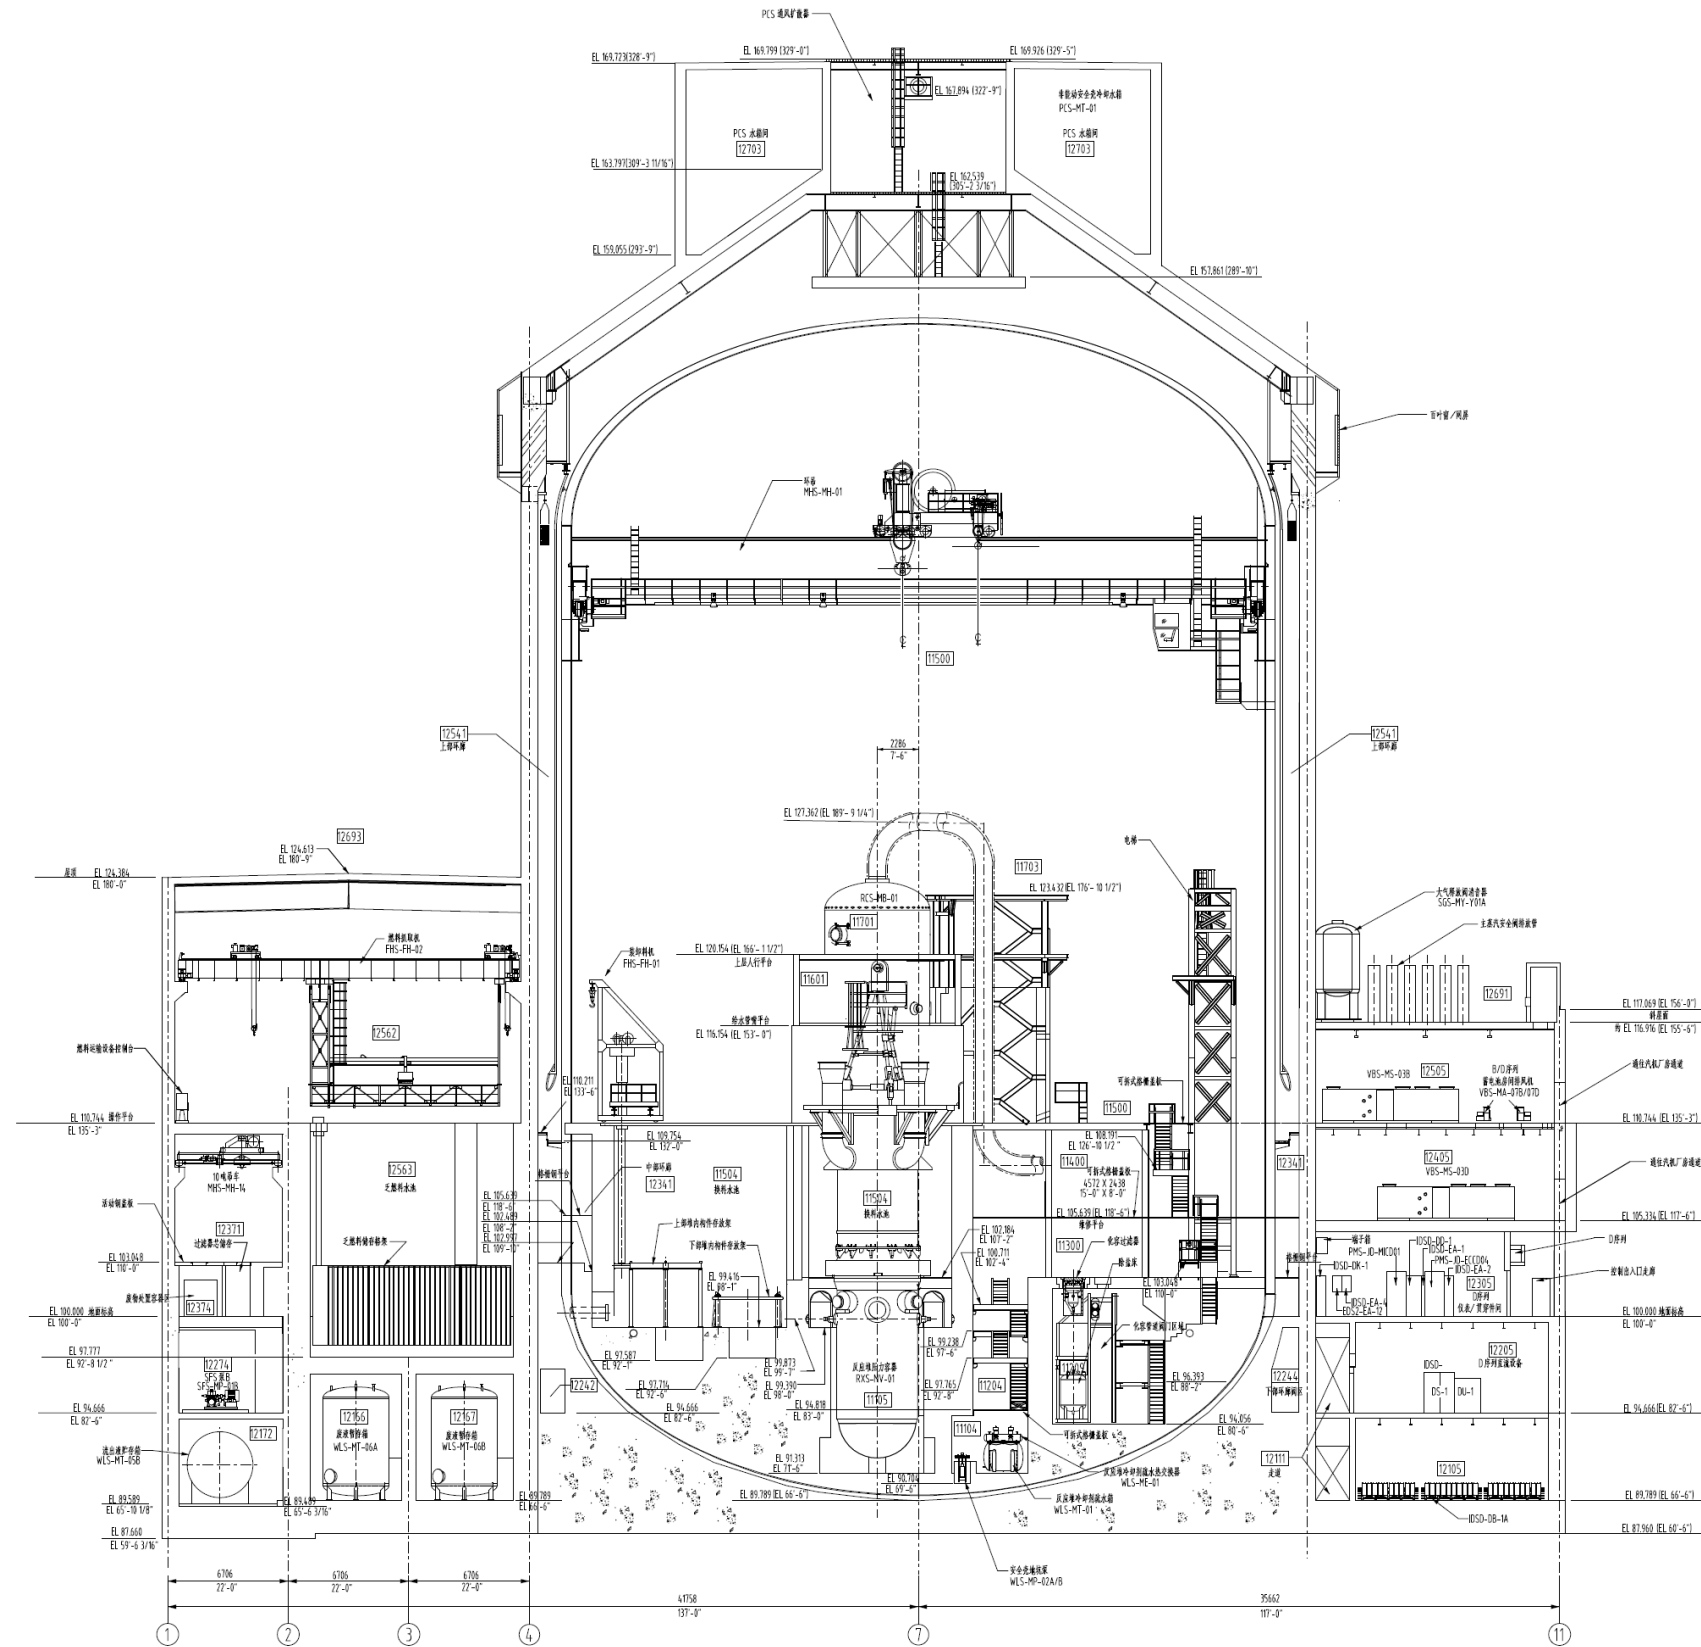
核岛厂房布置示意图 A-A 剖面
